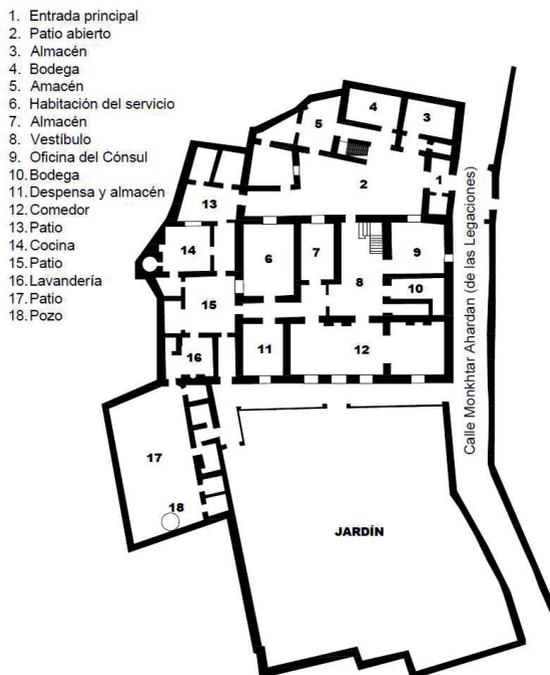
Planta baja del Consulado. Reproducción digital realizada por el autor a partir de un plano de 1887 (Works 10/53-3: 15).
